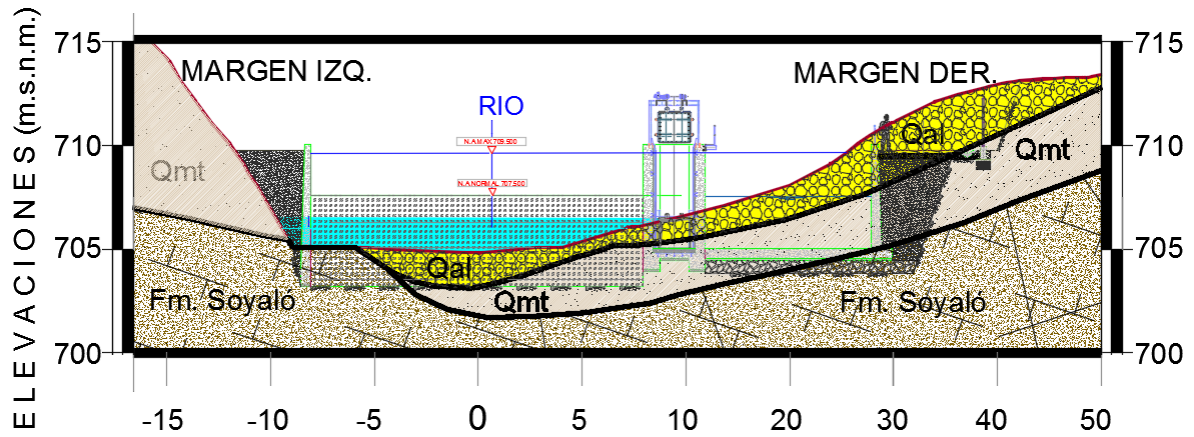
Sección geológica, en donde el desplante de la presa se encuentra en la elevación 703.2 m.s.n.m.
